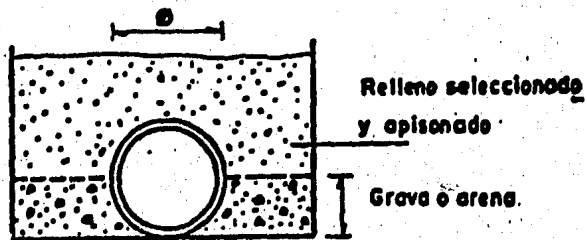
TUBO SOBRE TERRENO PLANO Y COMPACTADO
